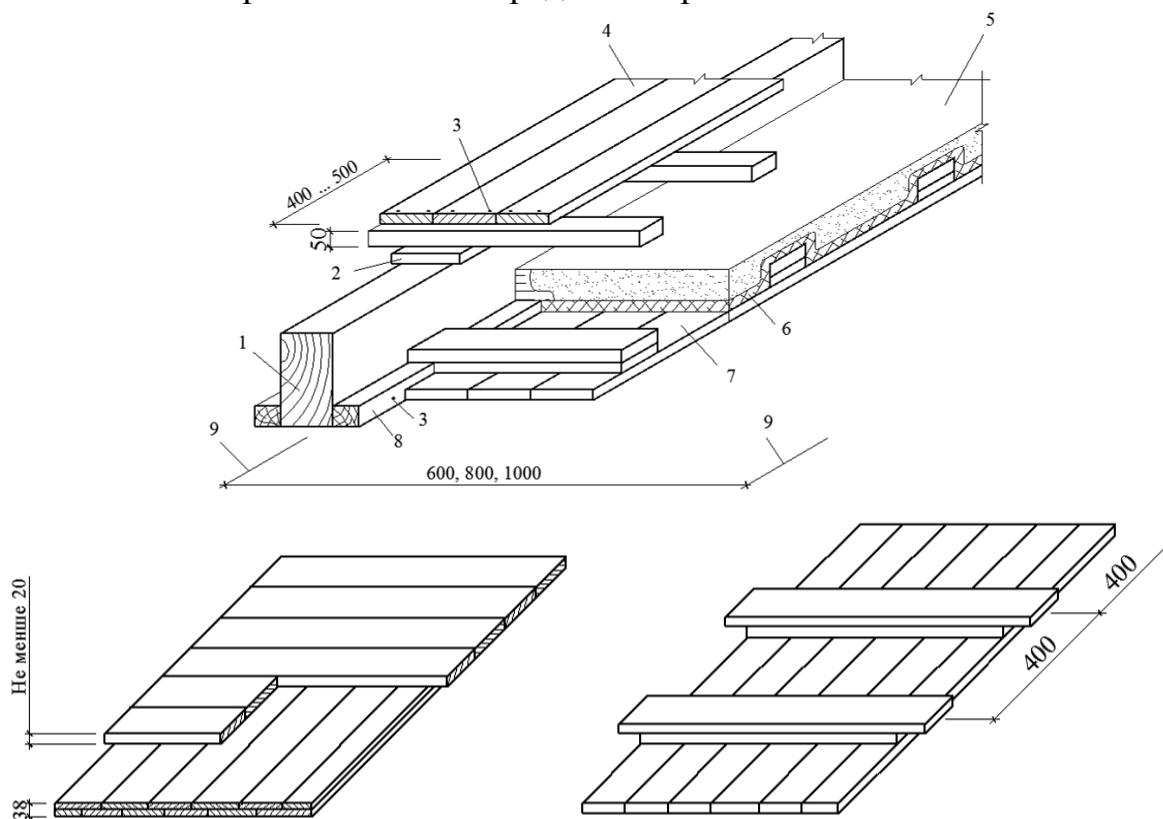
Конструктивна схема перекриття по дерев'яних балках:
